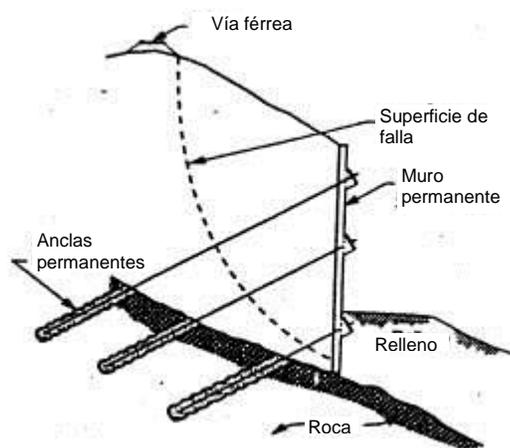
Ejemplo de un muro anclado para estabilizar un deslizamiento
